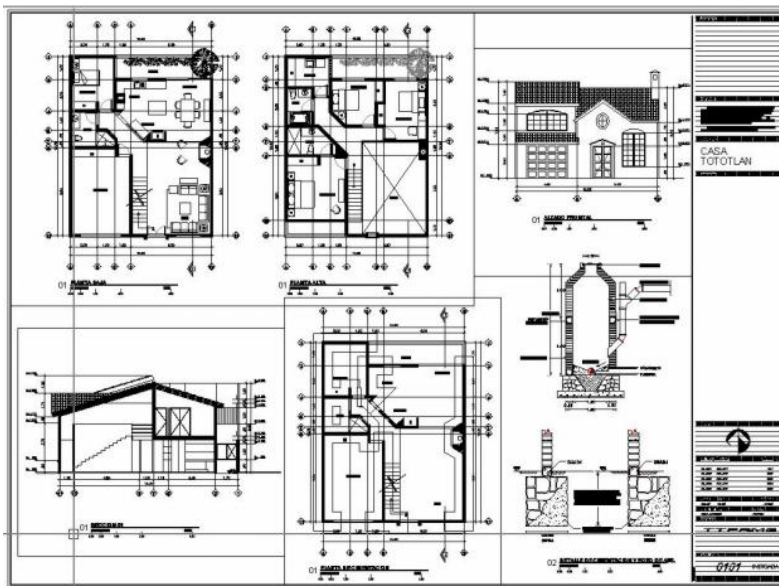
Plano de plantas de viviendas unifamiliar equipadas. Fuente: www.arquitectuba.com
